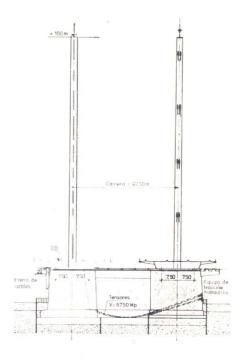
Puente Düsseldorf-Oberkassel - Pista de desplazamiento lateral en pila 6.
